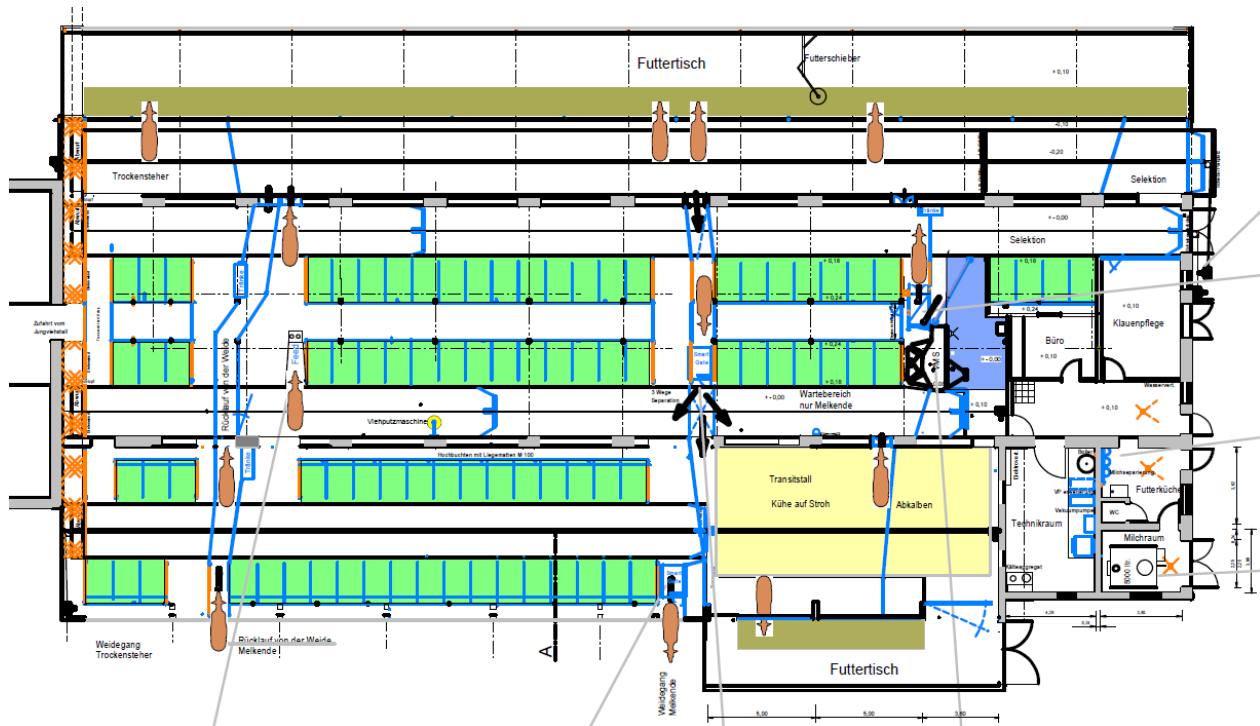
Stallgrundriss von Betrieb D (Quelle: DeLaval).
